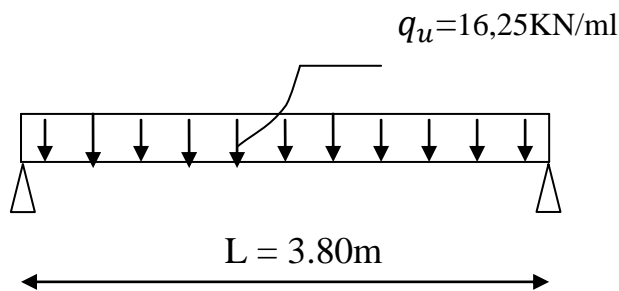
Schéma statique de la poutre de chaînage à l'ELU
